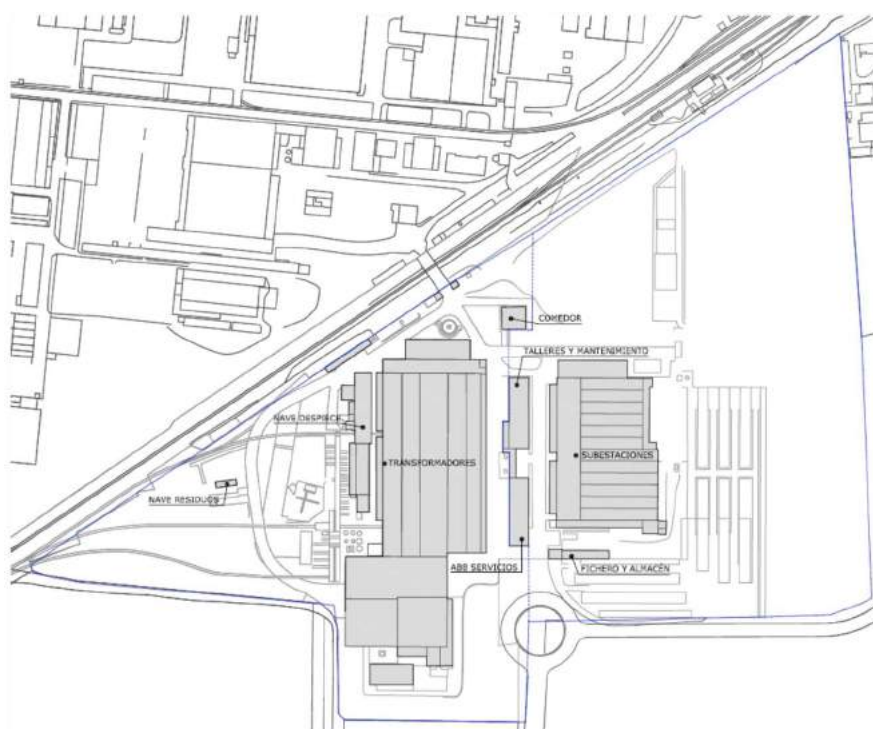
Planos edificios elaboración propiedad ABB.
